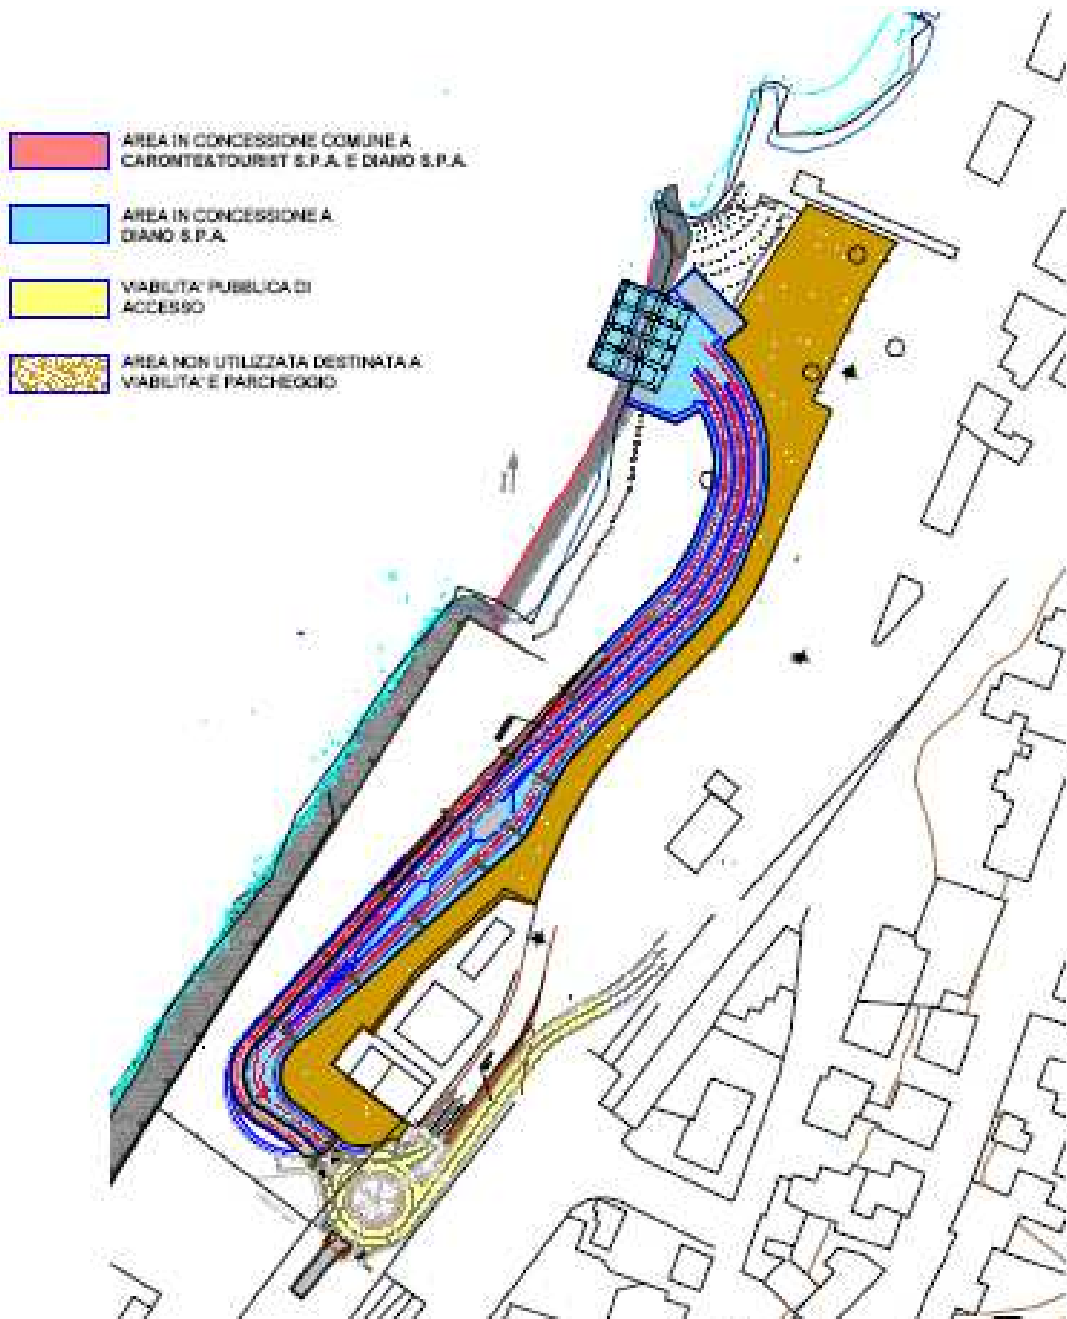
Planimetria generale dell'opera con destinazione delle aree
